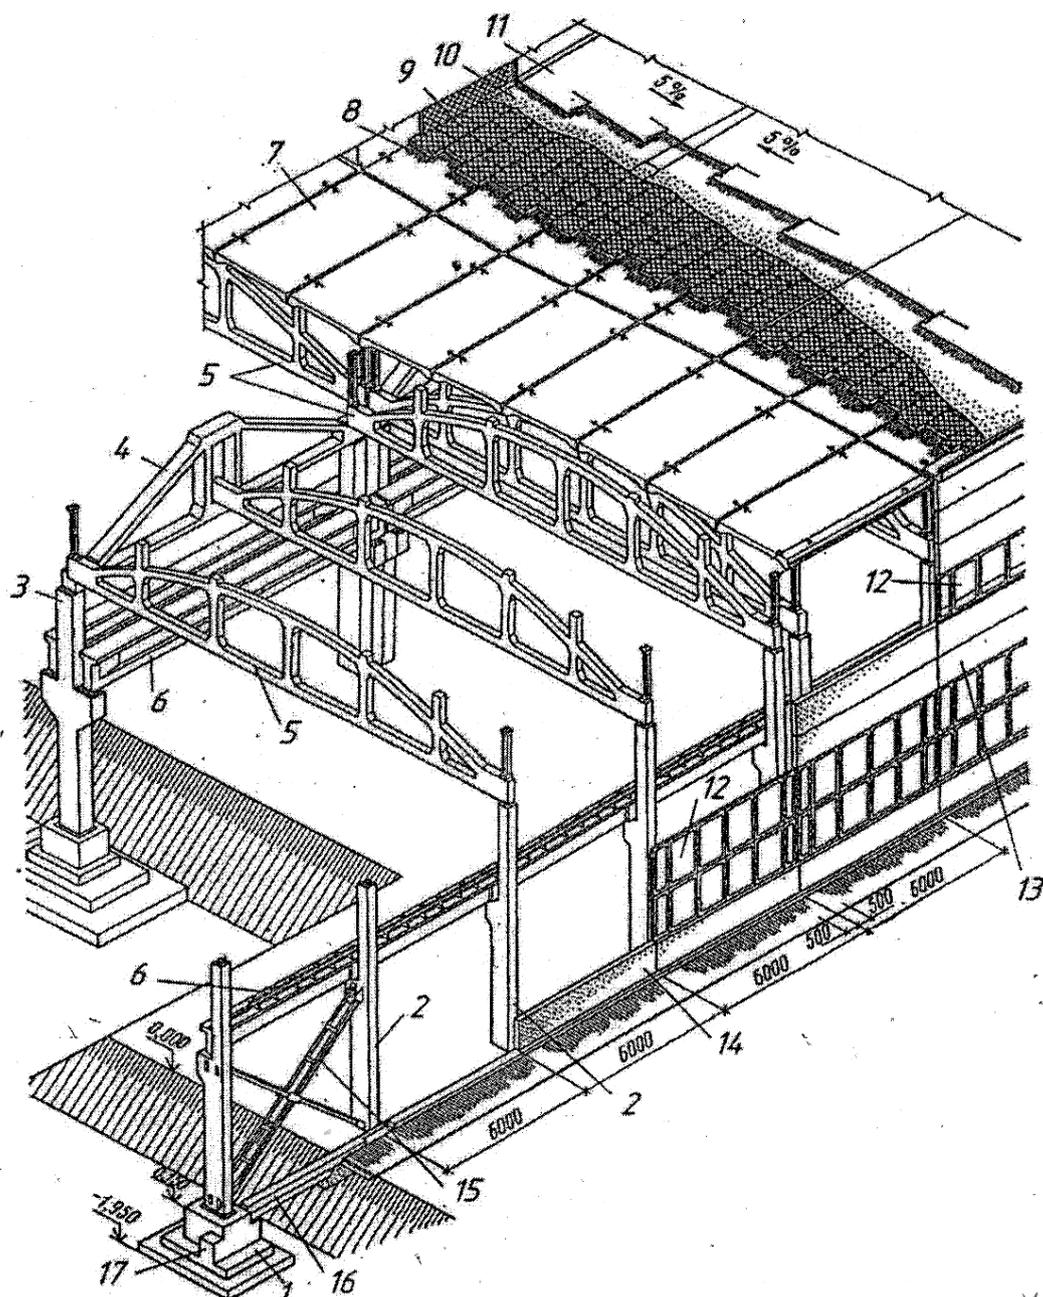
Конструктивное решение одноэтажного многопролетного производственного здания: 1 – монолитный железобетонный фундамент под колонну; 2 – колонна крайнего ряда; 3 – колонна среднего ряда; 4 – подстропильная железобетонная ферма; 5 – железобетонная малоуклонная ферма (стропильная конструкция); 6 – подкрановая балка; 7 – железобетонная ребристая плита покрытия; 8 – пароизоляция; 9 – слой утеплителя; 10 – цементная стяжка; 11 – водоизоляционный материал (наплавляемая кровля); 12 – остекление; 13 – стеновая панель; 14 – цокольная стеновая панель; 15 – металлическая крестовая вертикальная связь между колоннами; 16 – железобетонная фундаментная балка; 17 – бетонный подлив для опирания фундаментных балок
